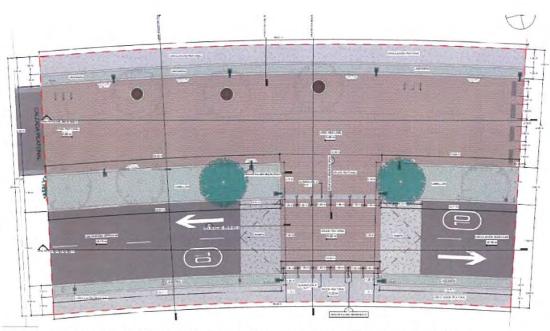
Planta de la plaza del desembarque en Estacionamiento Ecológico.
